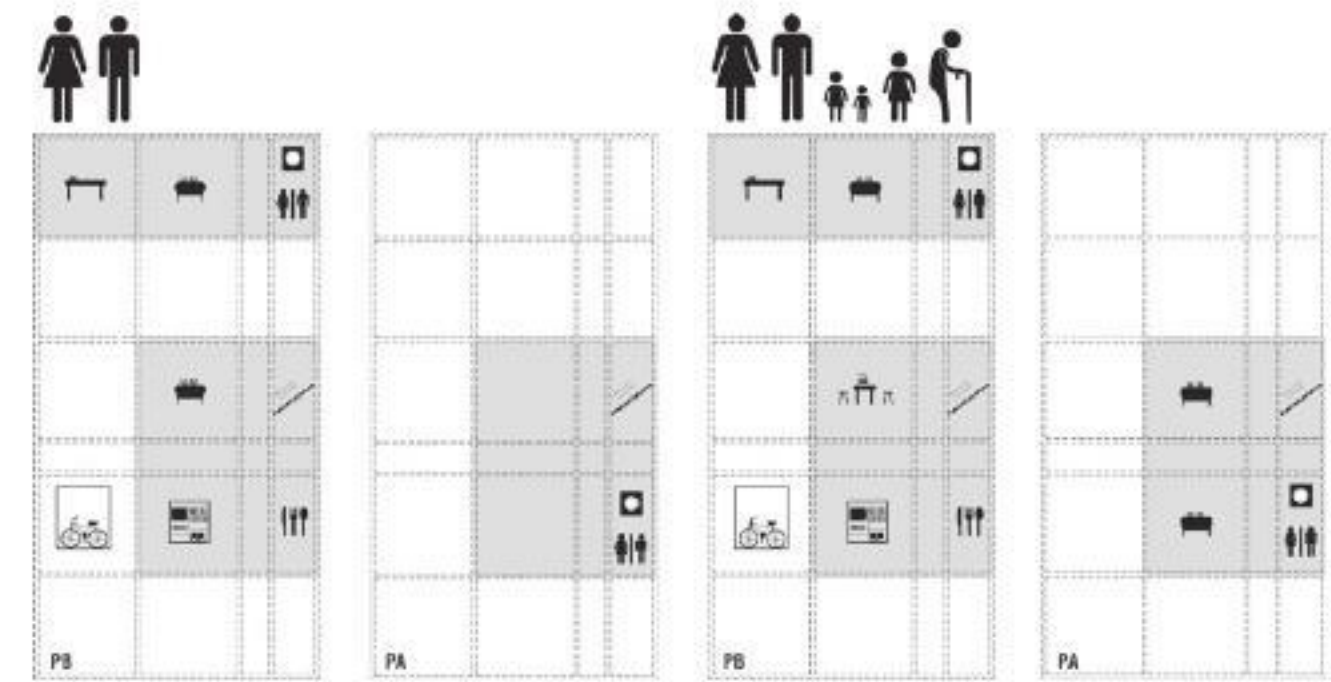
Caso 3. Plantas del desarrollo del plan de tránsito
